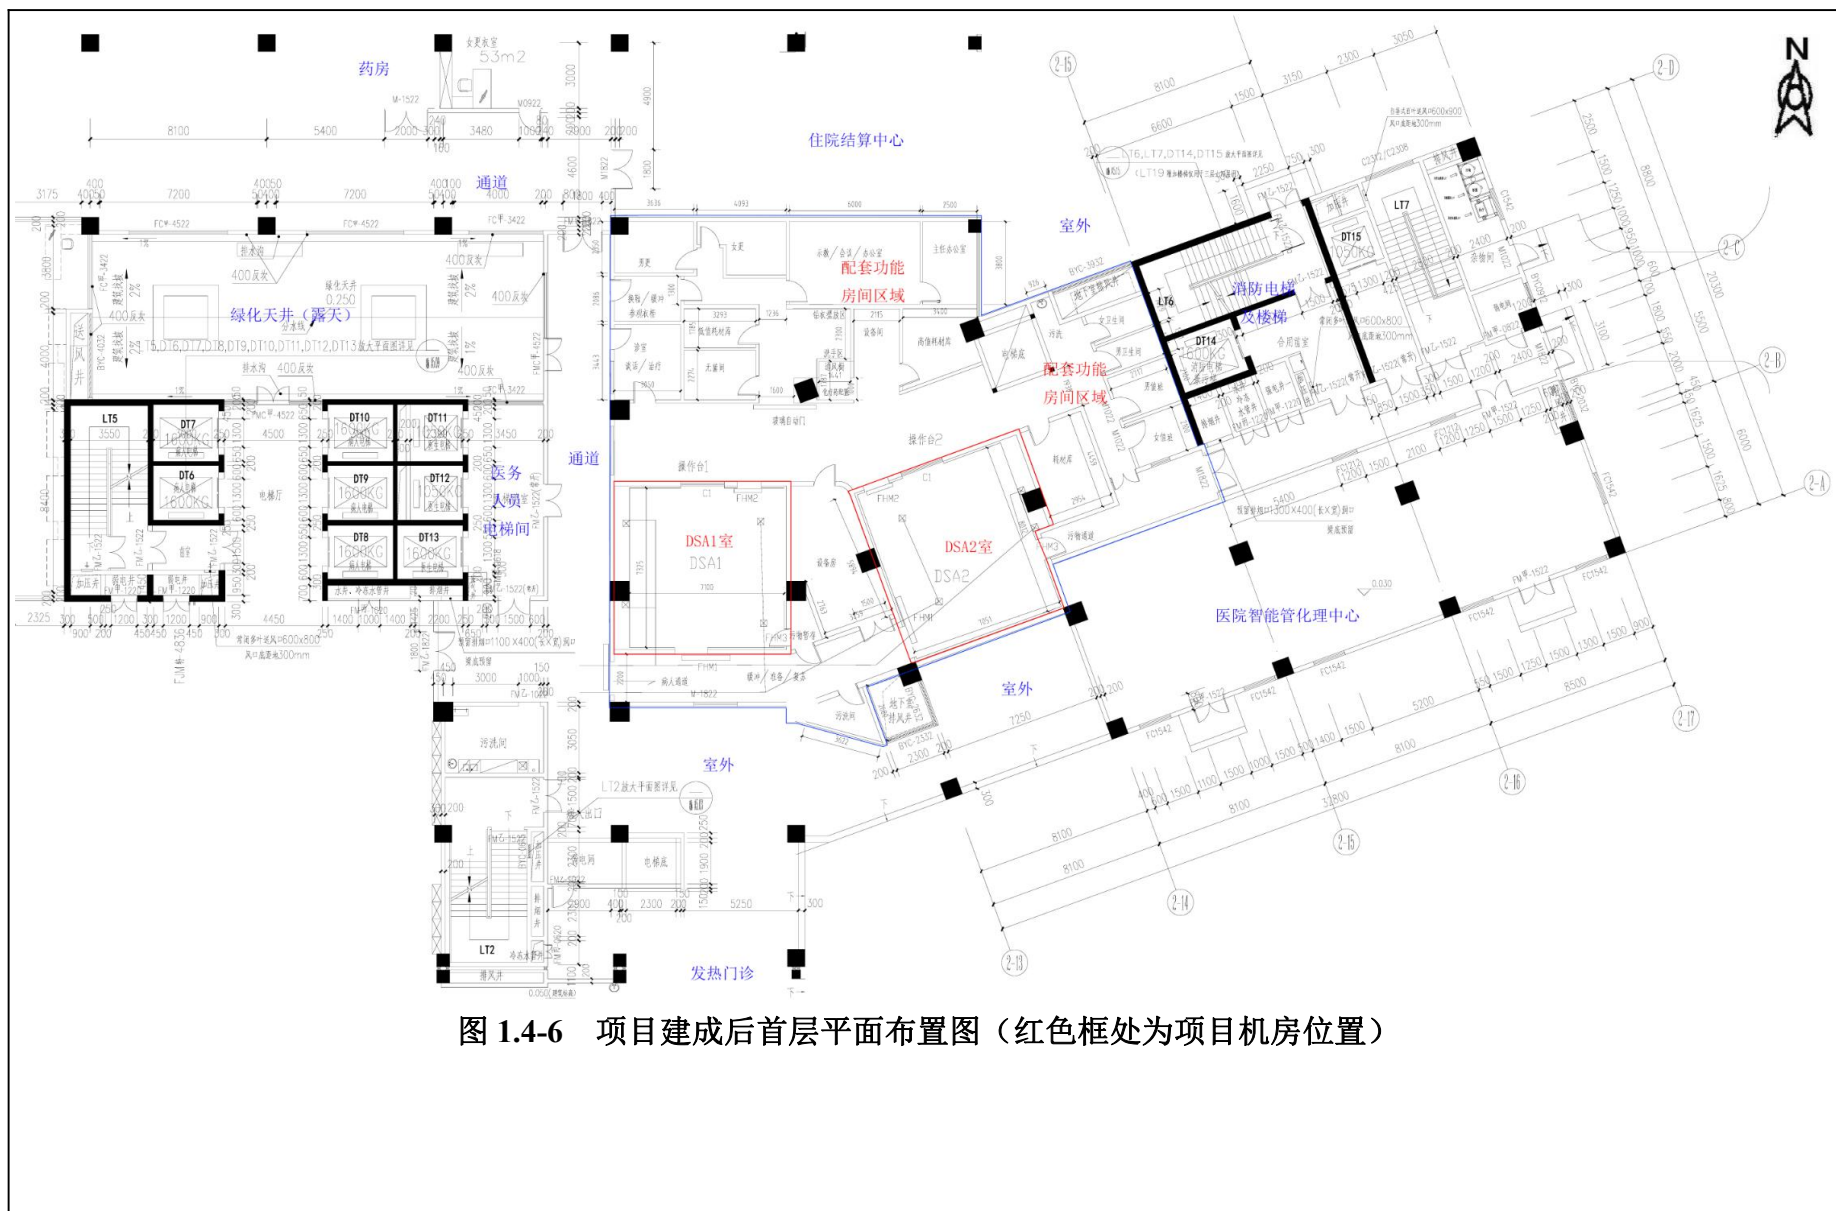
项目建成后首层平面布置图 (红色框处为项目机房位置)
